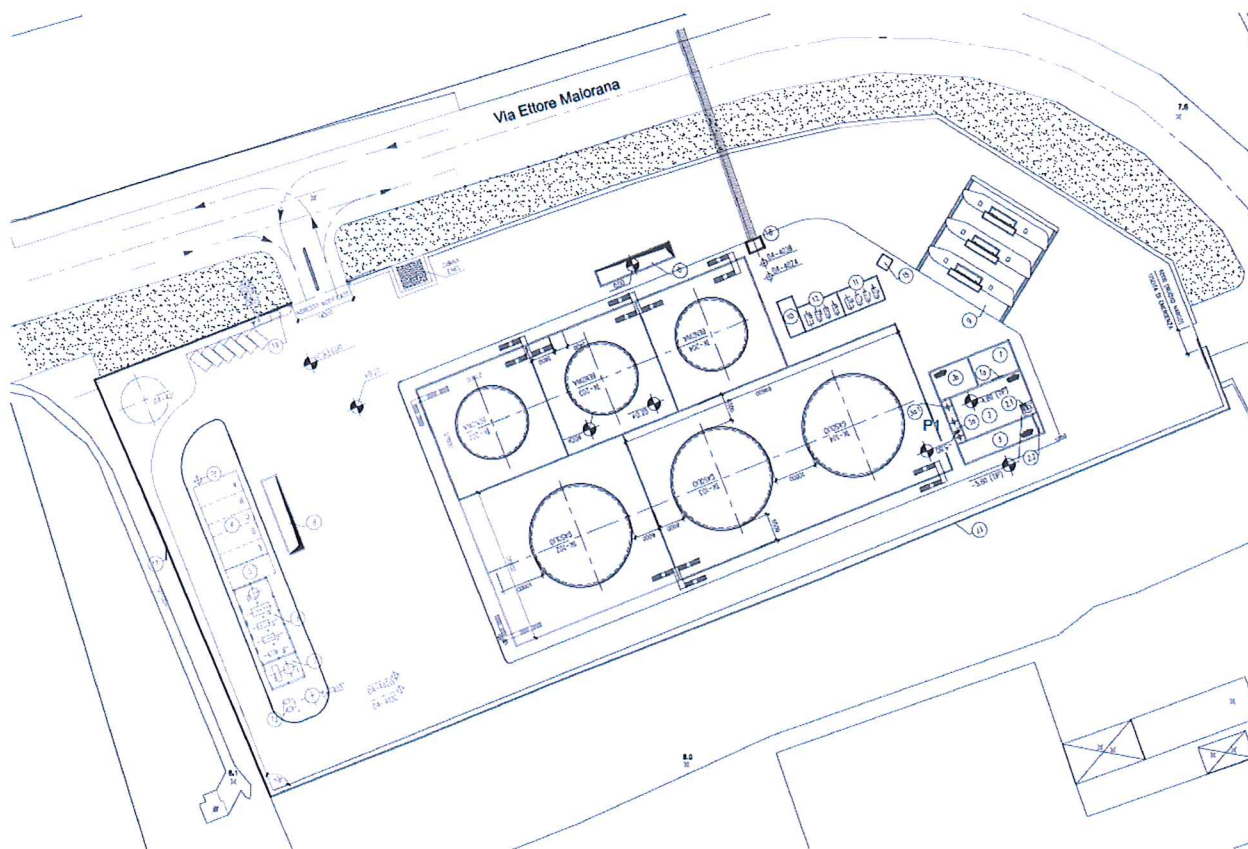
LAYOUT IMPIANTO DI STOCCAGGIO BRUNDISIUM
